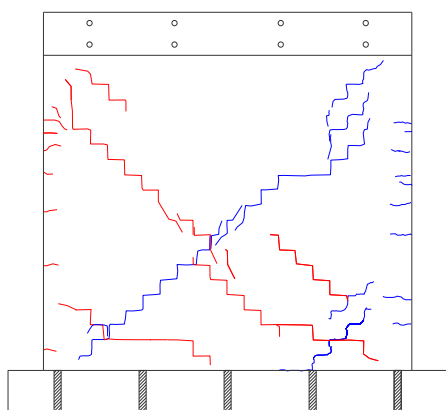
Reparación Tipo II en muro de albañilería confinada con ladrillos pandereta industrial en la distorsión 1/1500.
